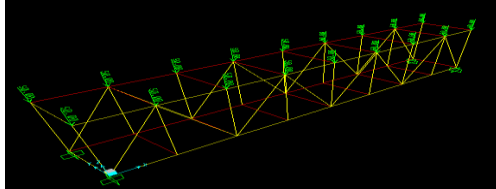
Tampak 3D struktur jembatan (sumber : Dokumen Pribadi)
